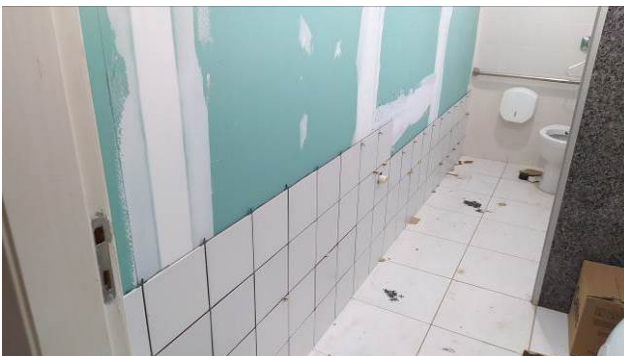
C: Início da instalação dos azulejos em parede de gesso acartonado verde, no sanitário PNE do primeiro pavimento.
